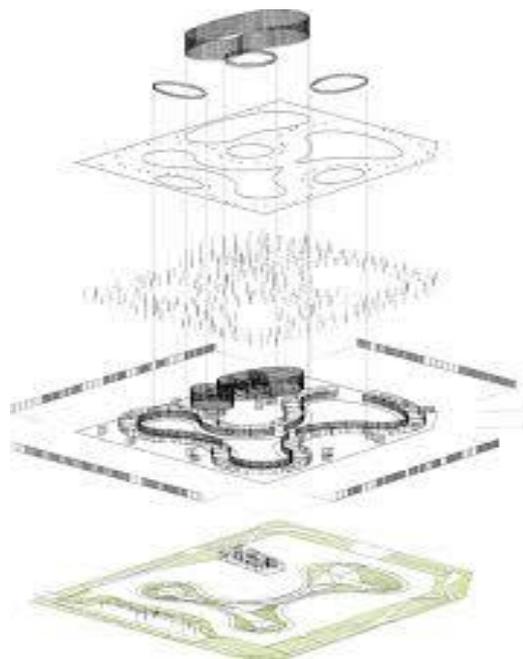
Nivel estructural del Centro Geriátrico De Santa Rita En Menorca – España
